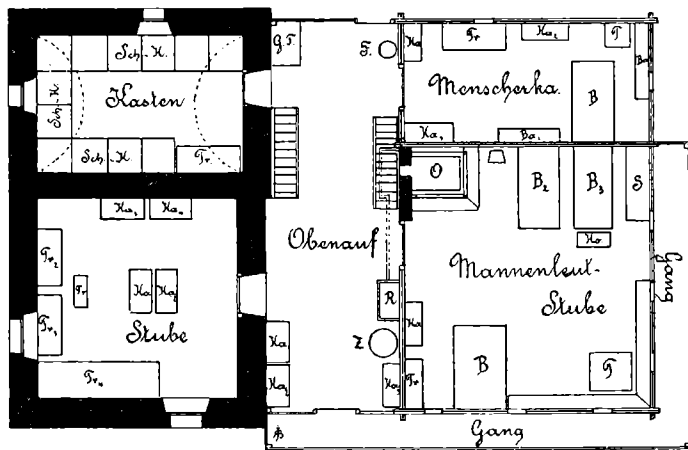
Grundriss des Obergeschosses des Jank-Hauses.
